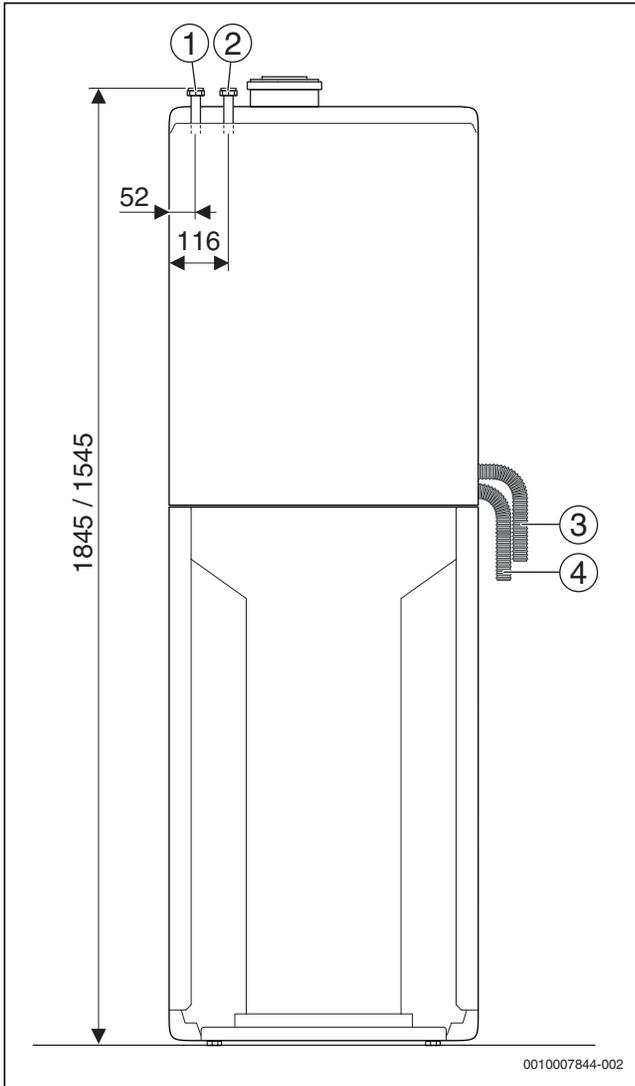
Anschlussmaße des Zubehörs Anschluss-Set Heizungsunterstützung HU (Maße in mm)
